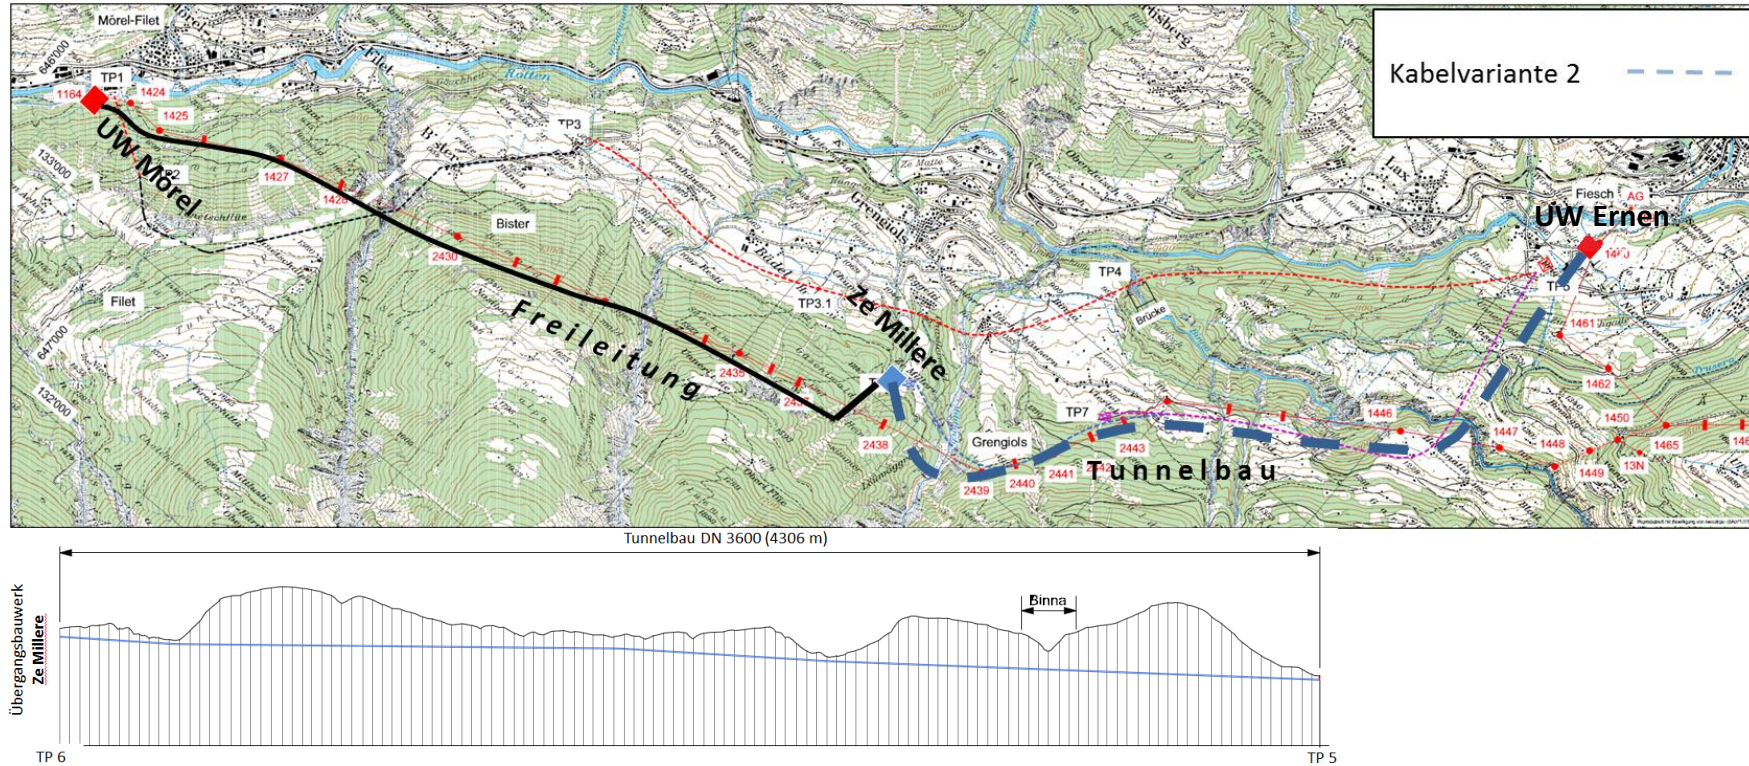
Skizzierung des Trassenverlaufs der Kabelvariante 2 im Lageplan (oben) und Höhenplan (unten)
